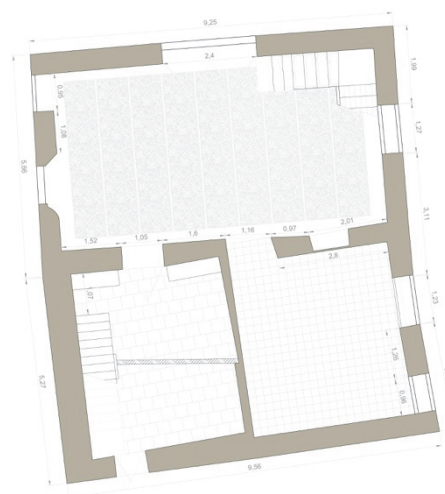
Plano de planta baja de la Alquería del Pollastre (Cuñat Tolosa et al.).
